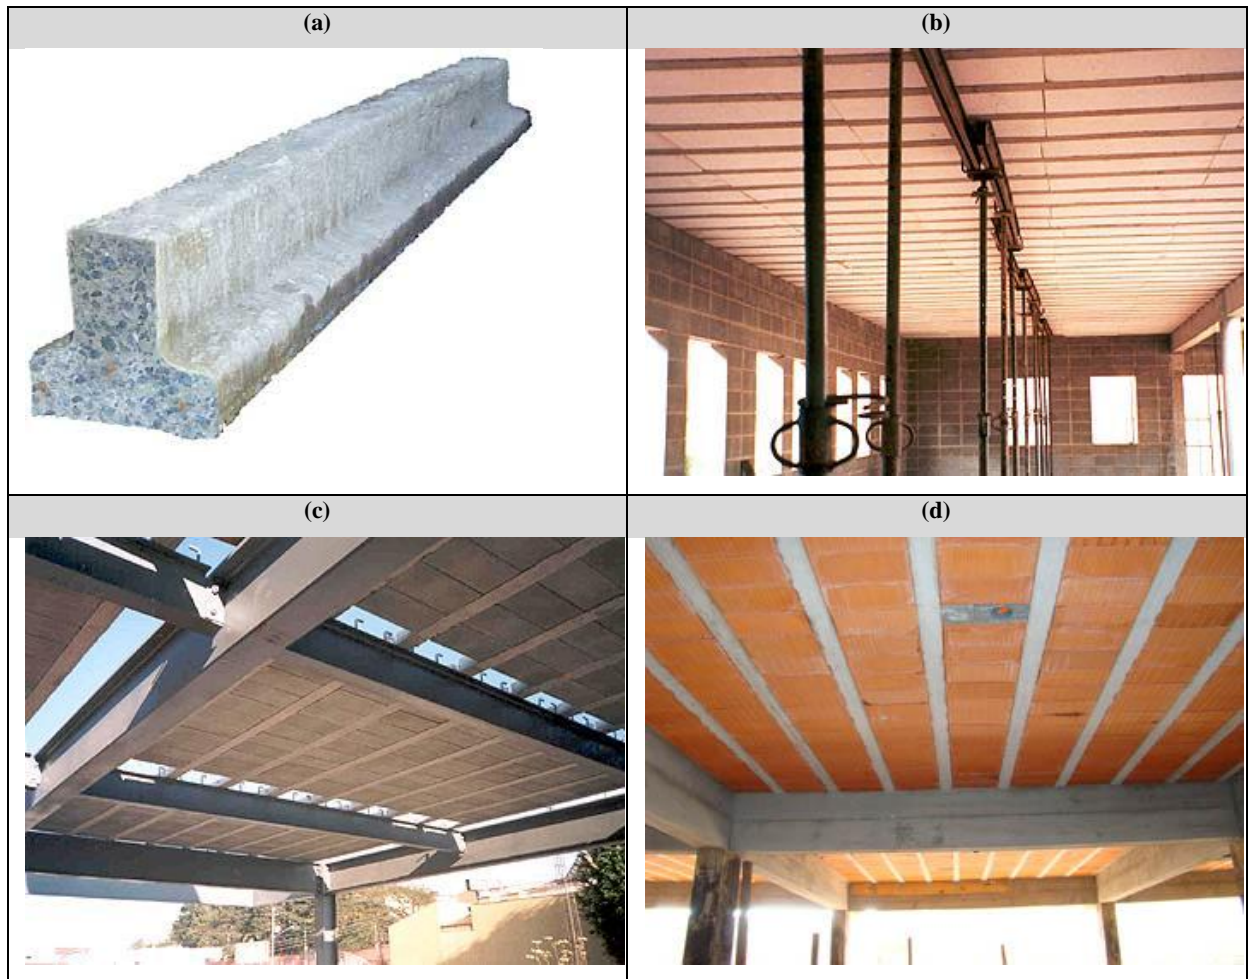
1 – (a) Trecho de uma vigota protendida; (b) Aplicação com elementos de EPS em estrutura de alvenaria estrutural; (c) Aplicação com lajota cerâmica em estrutura metálica; (d) Aplicação com lajota cerâmica em estrutura de concreto armado (FONTE: Tatu Pré-moldados)
